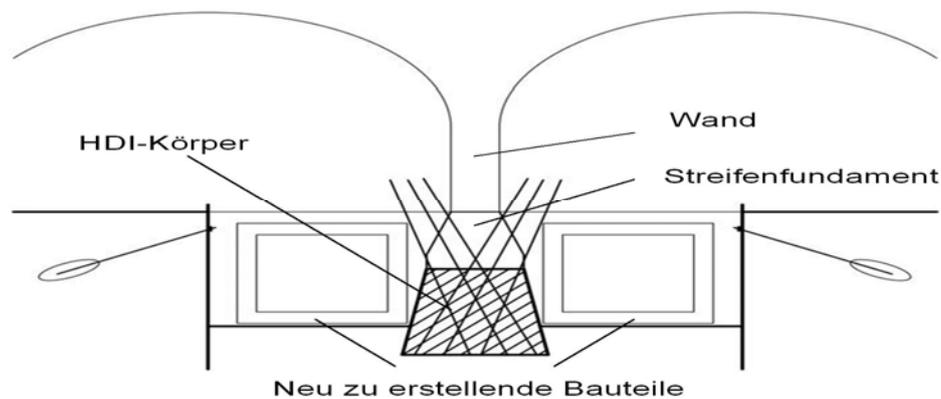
Anwendung einer HDI-Injektion zur Tieferlegung einer Gründung
